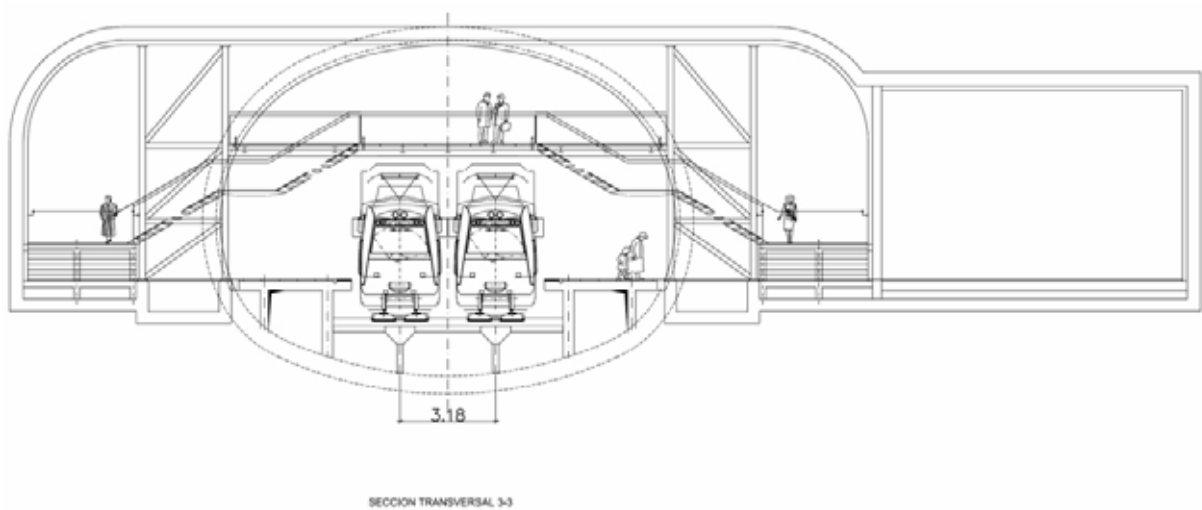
Techo plano en la sección transversal de la inserción de galerías laterales en una caverna
